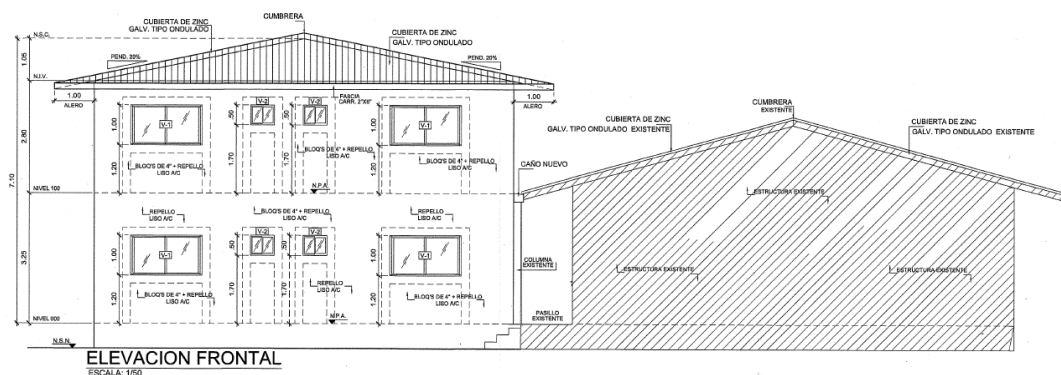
Elevación frontal del proyecto. Fuente. Plano del proyecto
